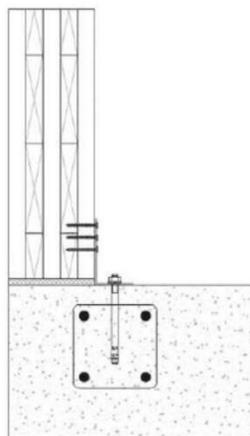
Assemblage mur-support béton par connecteurs tridimensionnels
